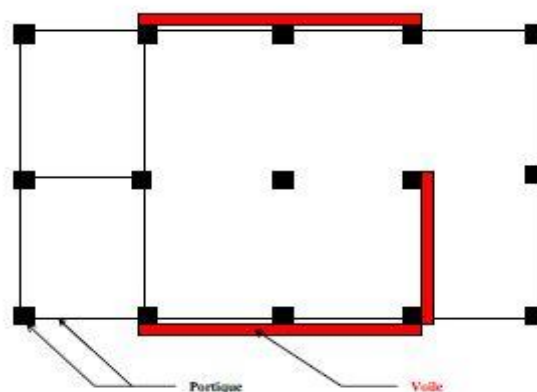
Contreventement Mix (Portique + Voile). [9]
